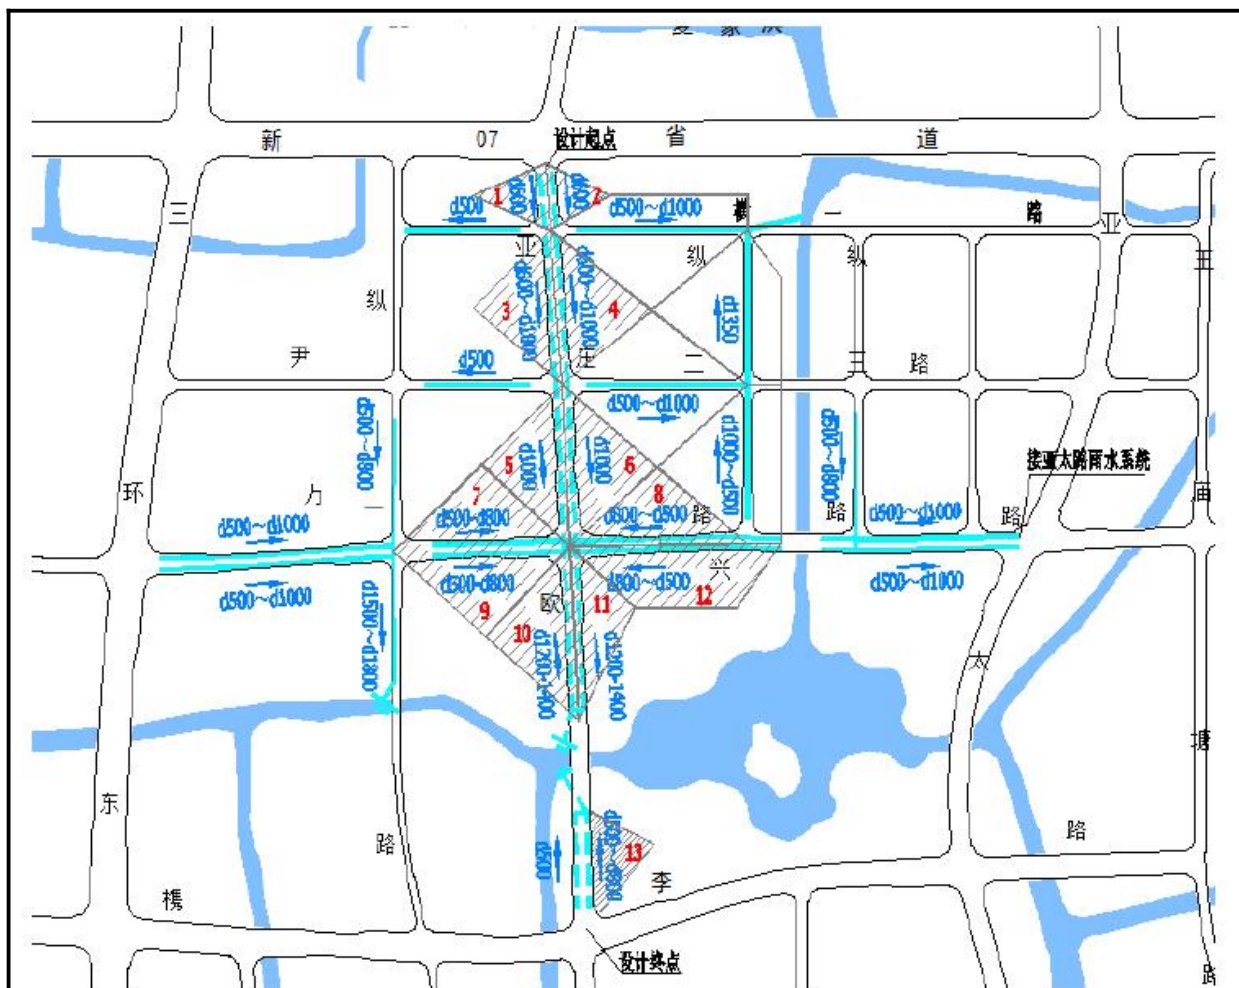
亚欧路（新 07 省道-携李路）段——雨水管线总平面布置图
